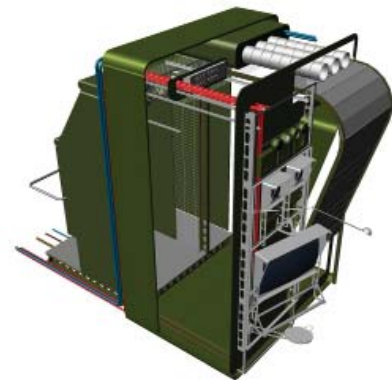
Detall del B03\_PLUG-INS TÉCNICO.
